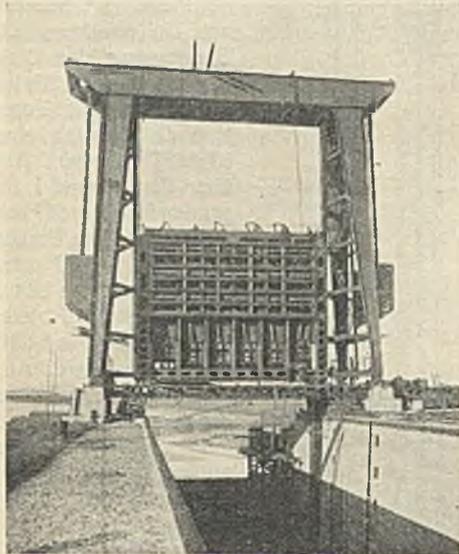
Untertor von Oberwasser. Anhängen der Gegengewichte mit Hilfe der Laschenketten. Zur Montage der Torführungen unter Wasser sind die Dammbalken eingesetzt. (Schleuse Flaesheim.)
